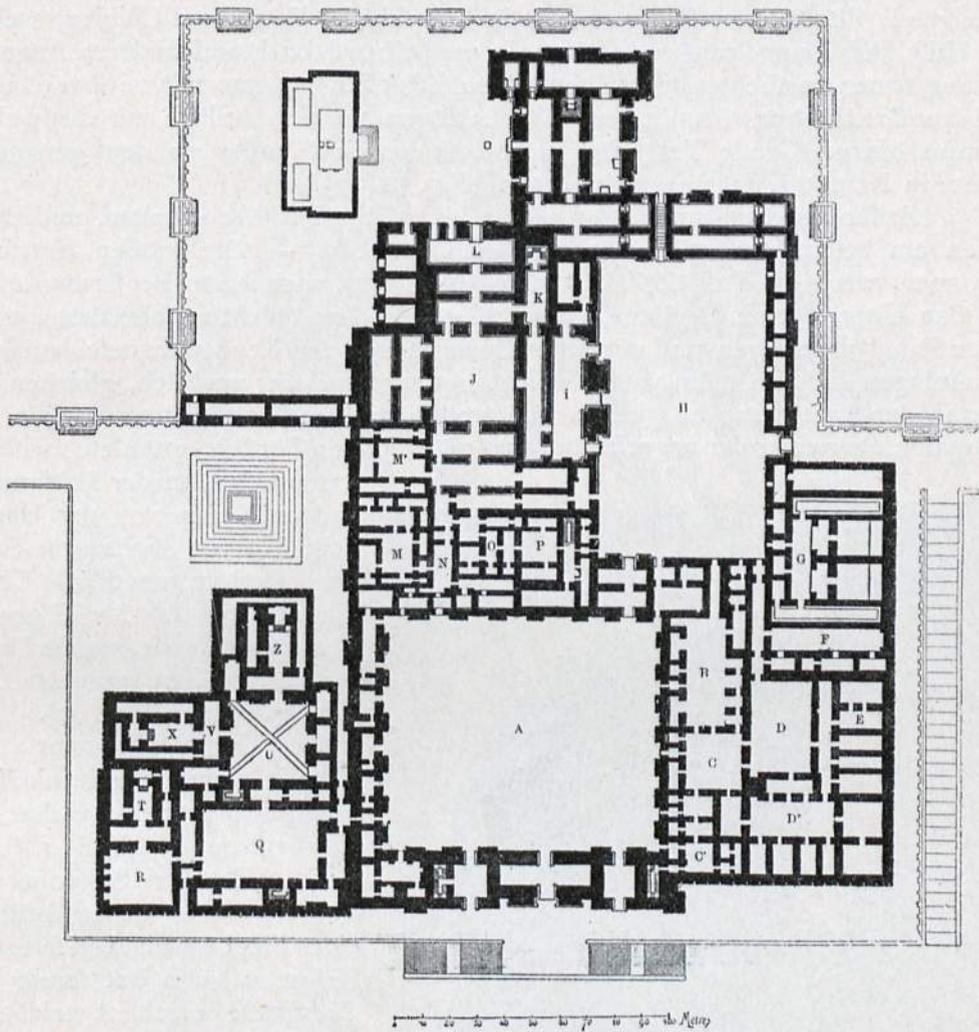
Grundriß zum Palaste Sargons zu Chorfabad. Nach Place.
